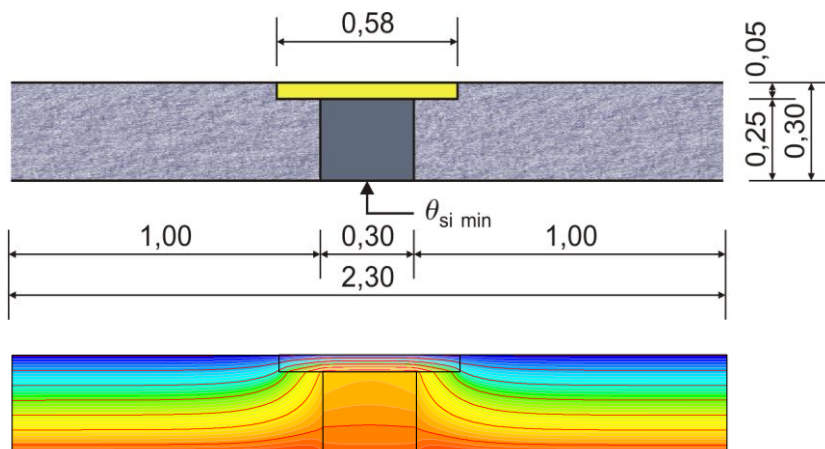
Детайл W7. Стена от клетъчен бетон с колона и топлоизолация, 46 cm – схема и изотерми
